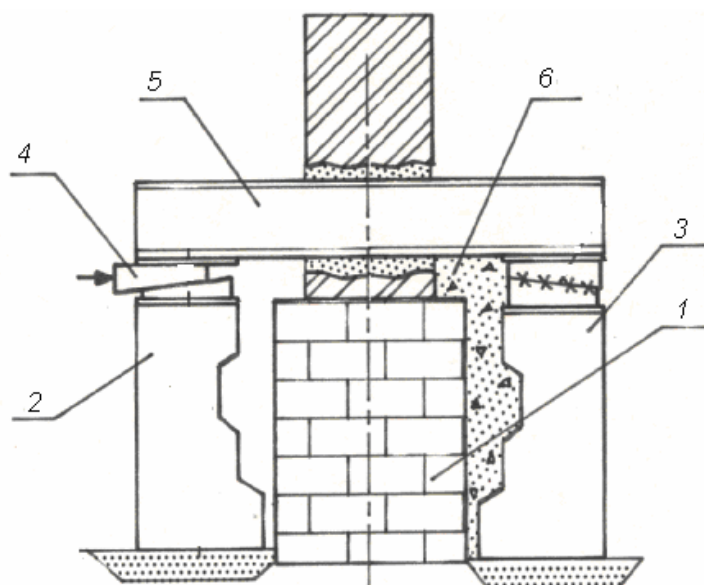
Уширение подошвы фундамента железобетонными банкетами с предварительным обжатием грунта: 1 – существующий фундамент, 2 – банкеты до обжатия, 3 – банкеты после обжатия, 4 – клинья, 5 – опорная балка, 6 – мелкозернистый бетон замоноличивания
